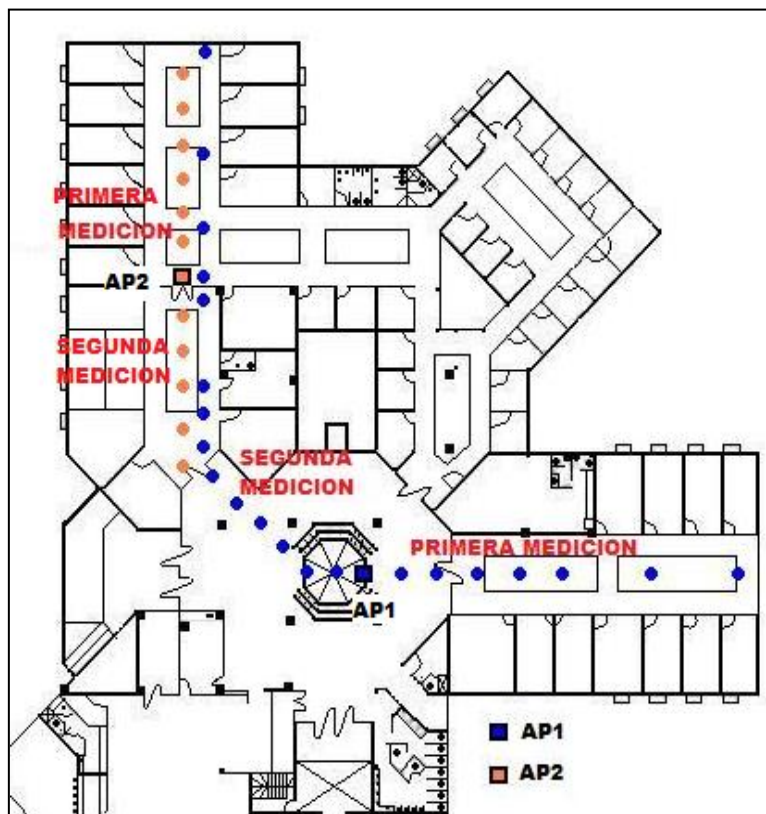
Plano de la planta baja del edificio administrativo de la FIEC.
